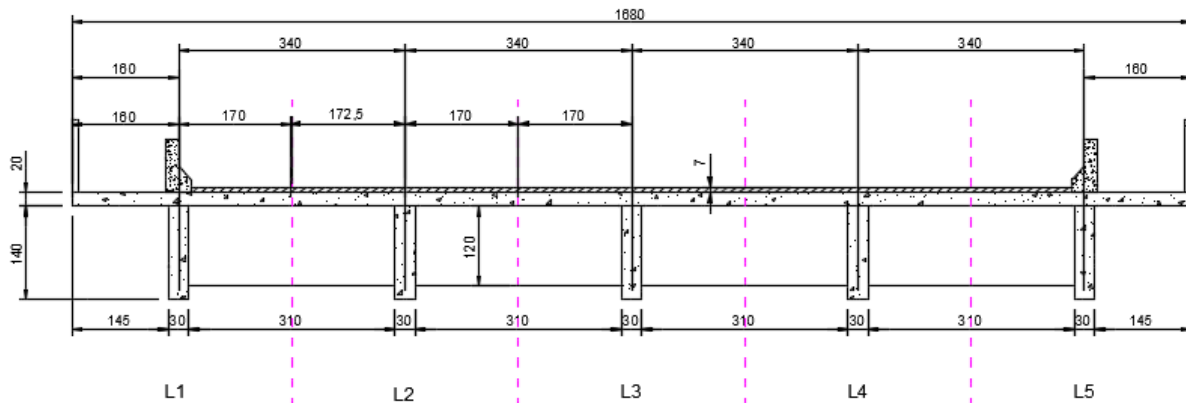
Seção transversal da ponte 2 (dimensões em cm)
